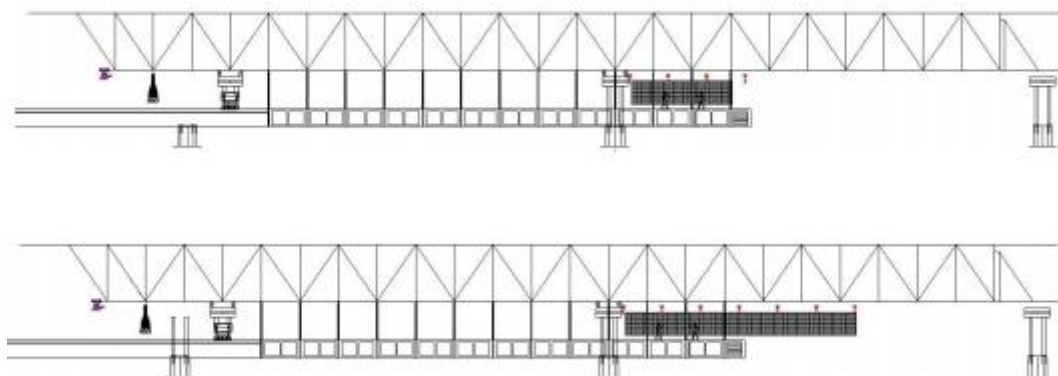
| 18 – Cura do betão e pré-fabricação da armadura [24]
